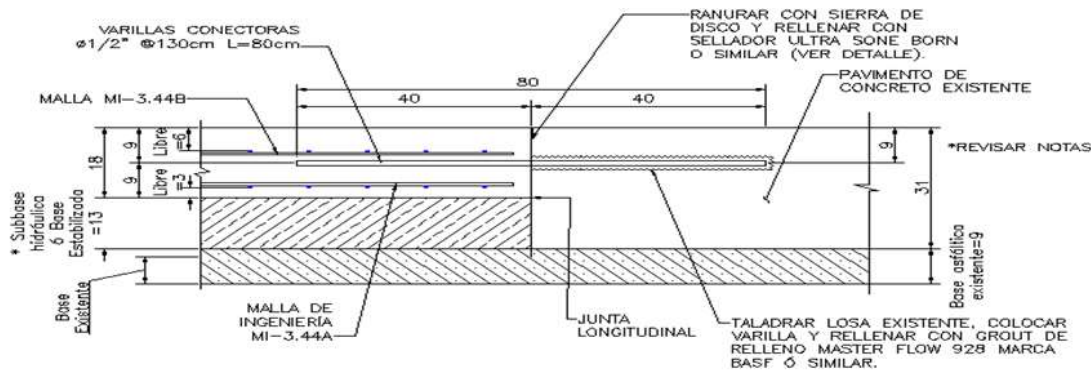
Sección transversal de la junta entre PCERC y Pavimento existente
